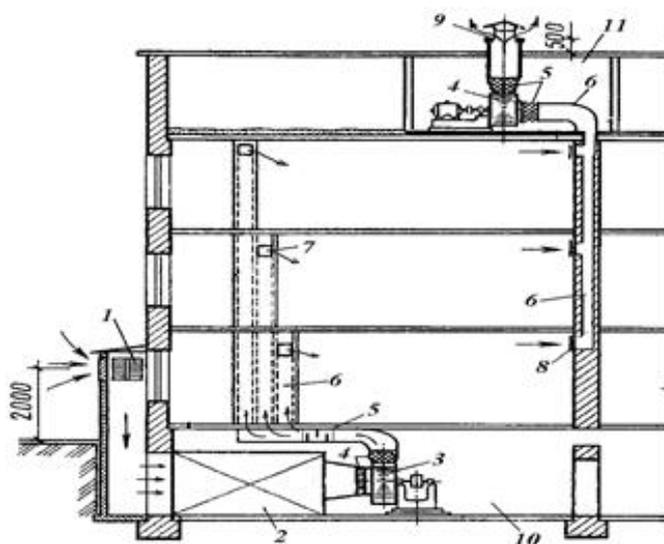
Вентиляция помещений с использованием приточной и вытяжной общеобменных систем механической вентиляции:
